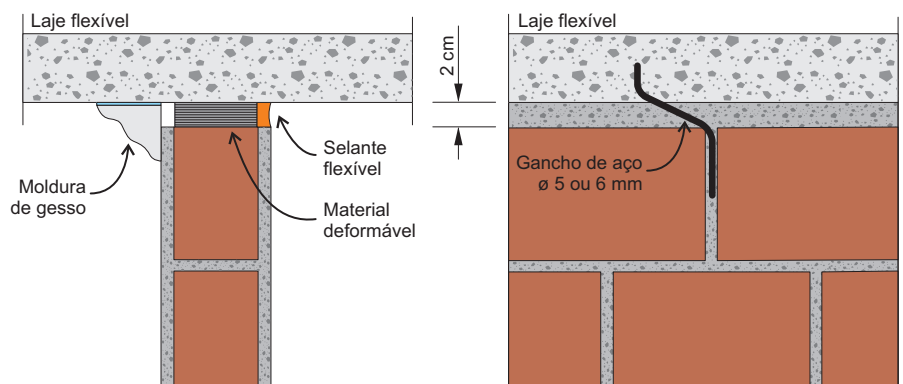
Detalhes de ligação das alvenarias com viga ou laje muito deformável.
